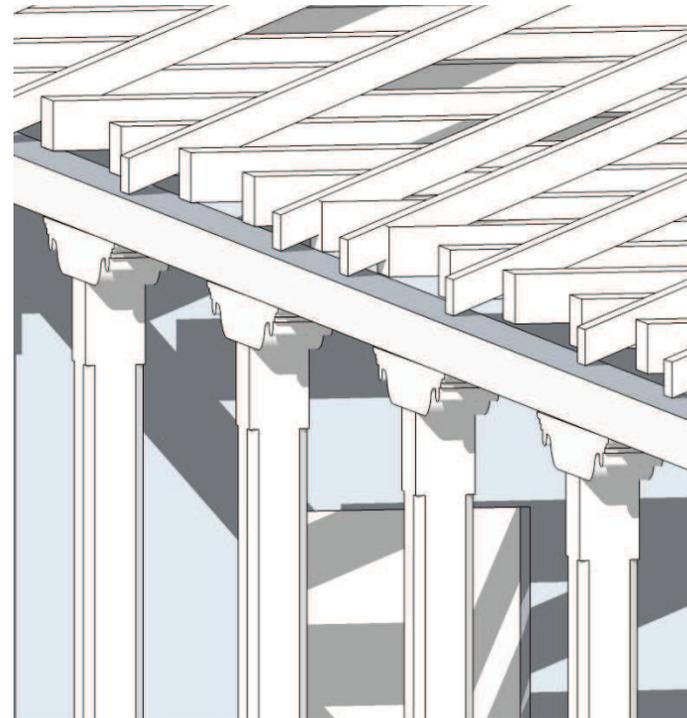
detalle viga de madera pasillo exterior, Casa Parroquial.
